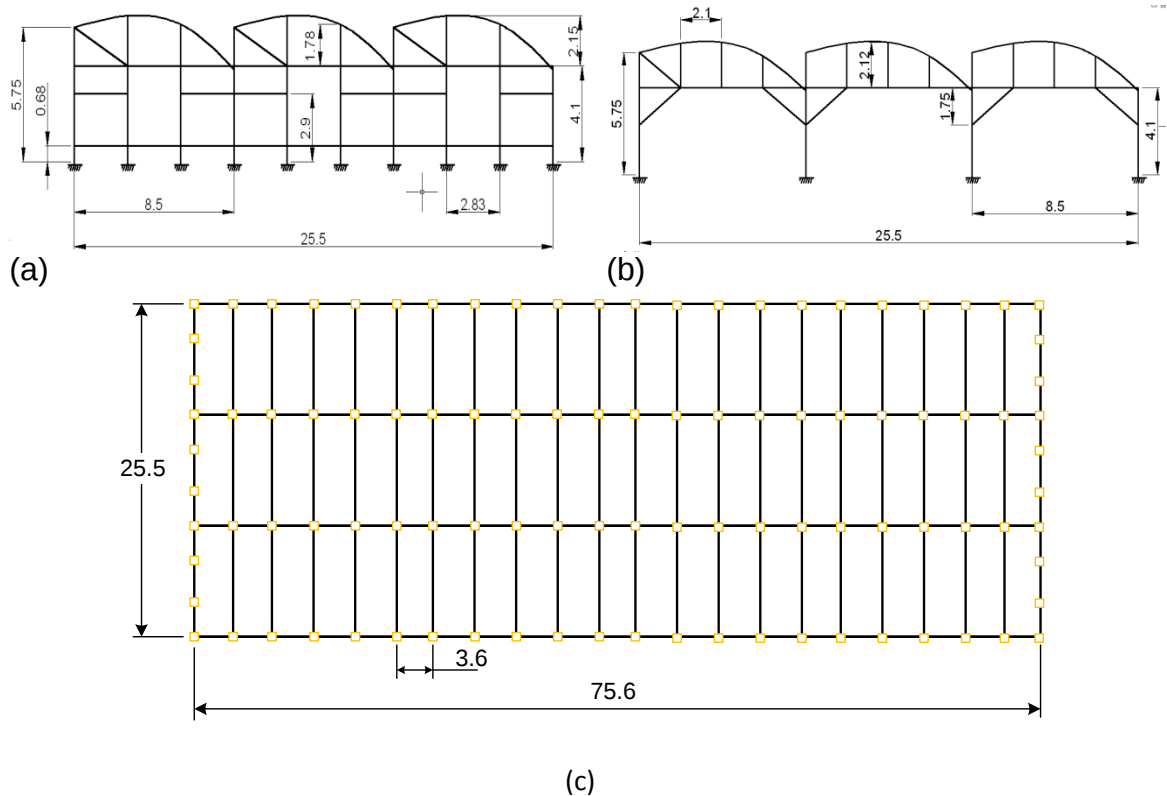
Diferentes vistas del invernadero, a) sección transversal cabecera, b) sección transversal interior y c) vista de planta. Acotaciones en m.
